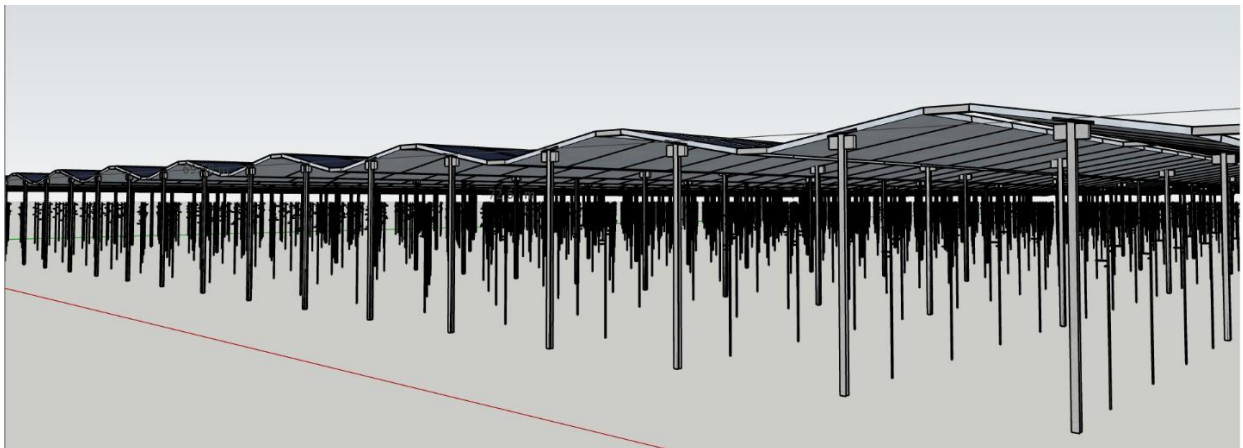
Vue d'ensemble d'une première idée de l'installation projetée. Vue du dessous.
